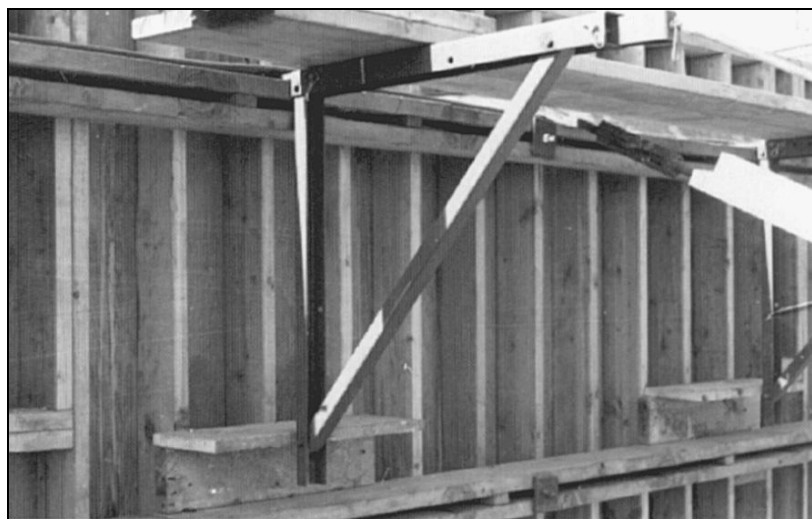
Стенные кронштейны могут быть установлены на бетонную опалубку
